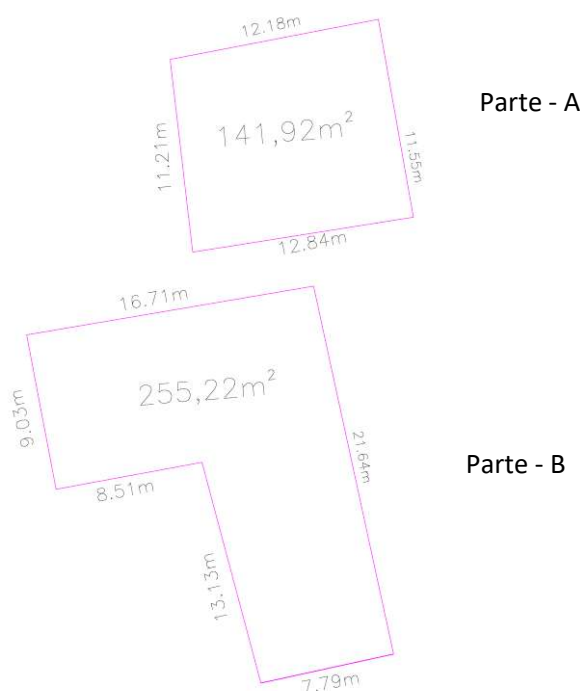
Desenho das edificações existentes, a partir do levantamento cadastral.
